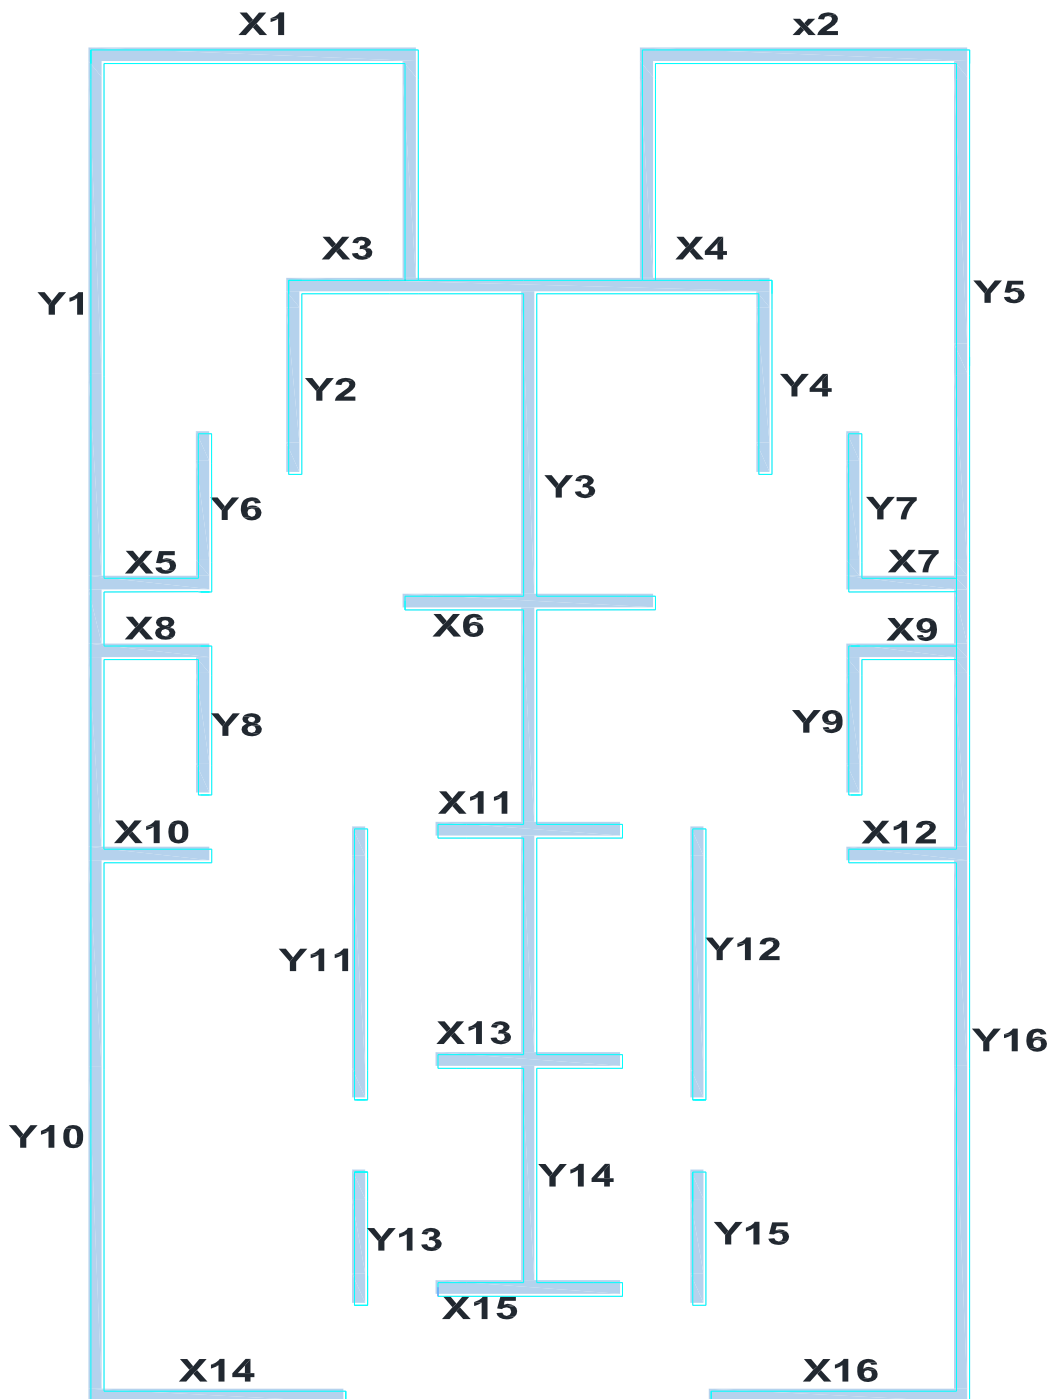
Esquema de Muros de Albañilería Confinada (AC)
